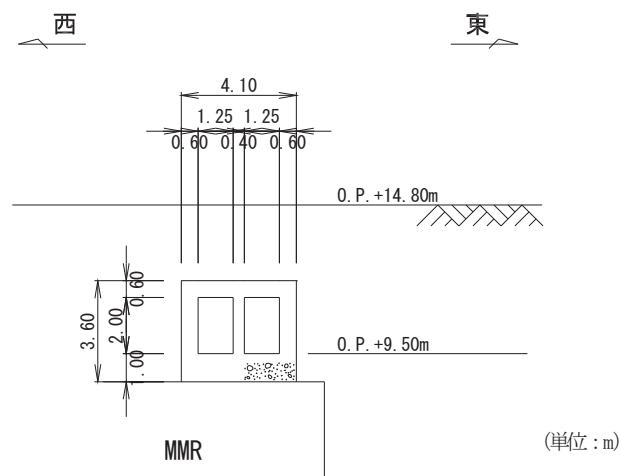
軽油タンク連絡ダクト断面図（標準部, A-A）
